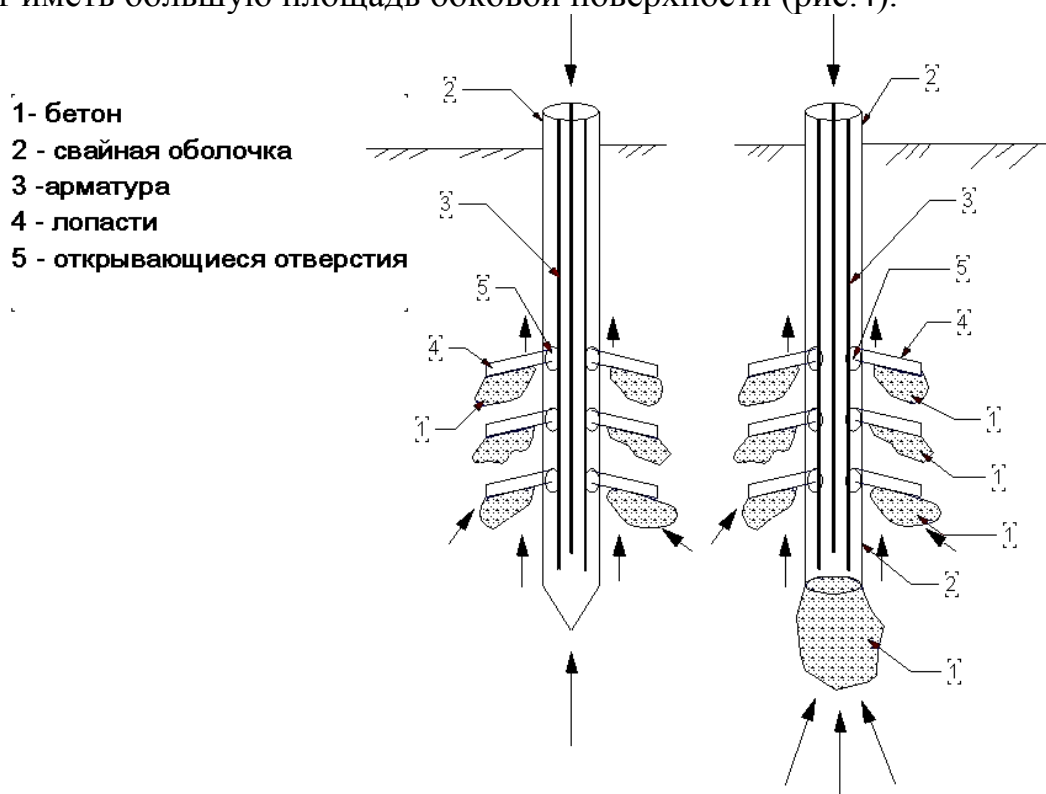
Оптимизация монтажа свайных конструкций фундаментов
